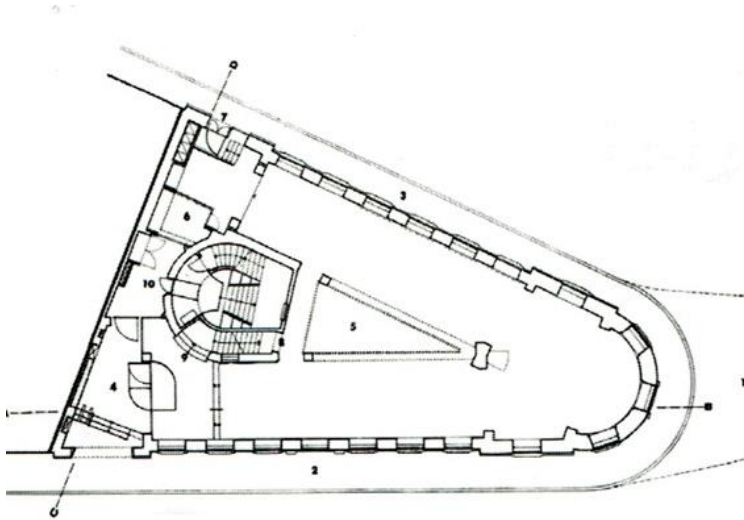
Grundriss Zentralsparkasse am Sparkassenplatz,
